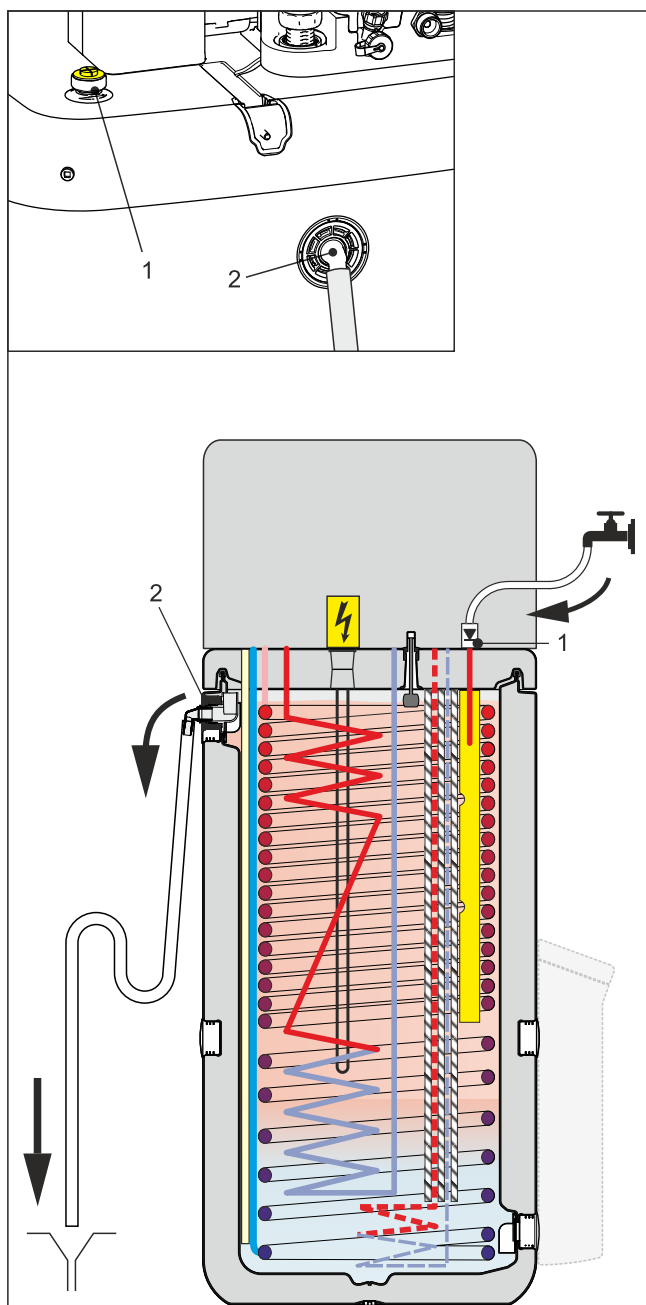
Riempimento serbatoio ad accumulazione inerziale - senza sistema solare DrainBack collegato
